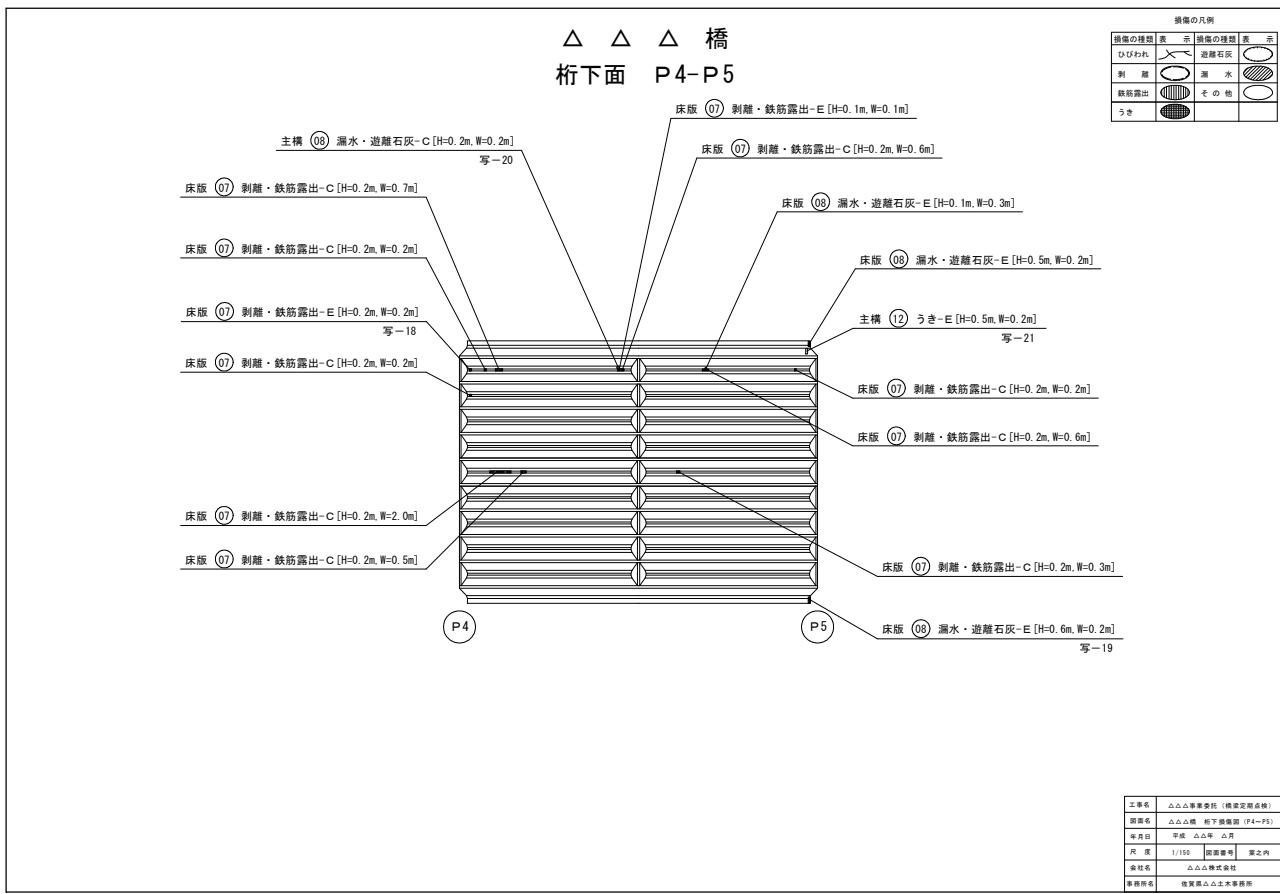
損傷図の記入例（桁下面：コンクリート橋）
